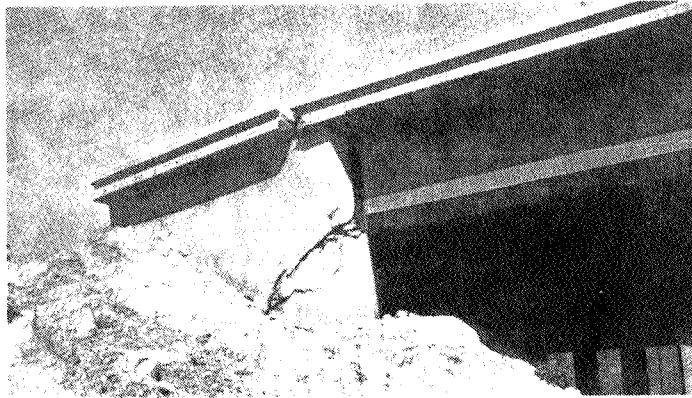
Fissuration du mur en retour d'une culée. San Fernando (1971).
